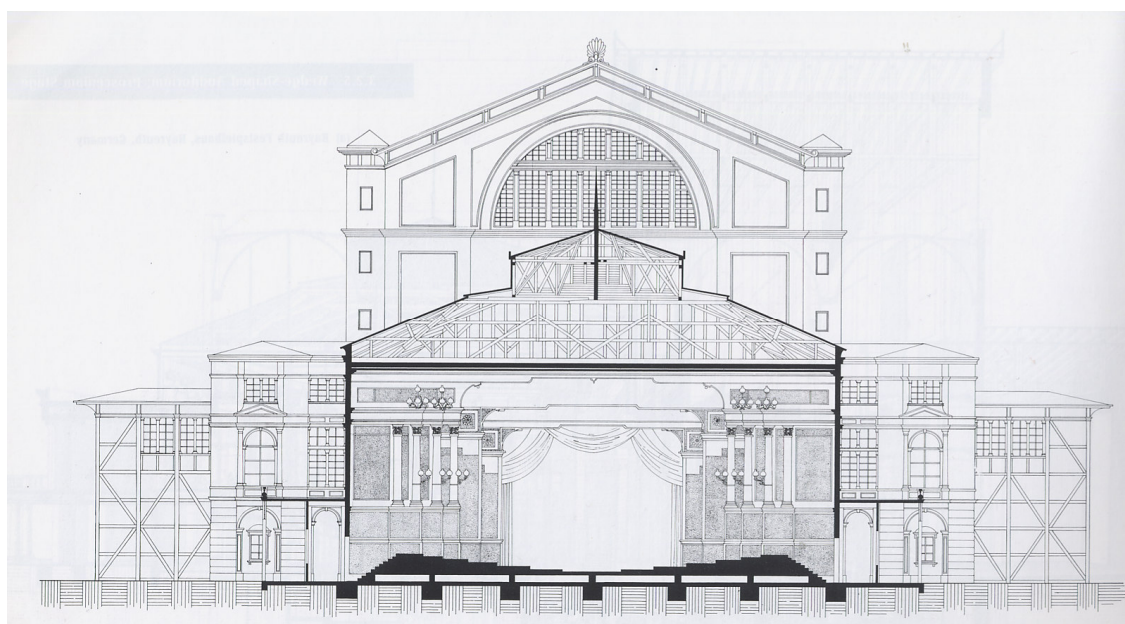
Sezione trasversale della sala del Bayreuth Festspielhaus.
